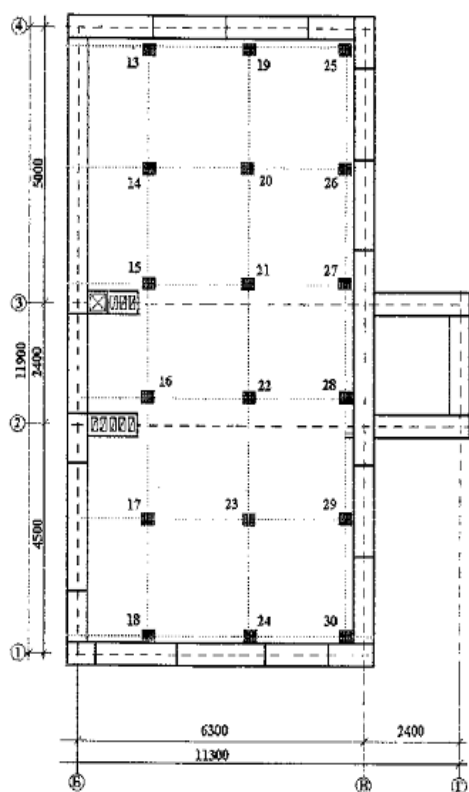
План расположения точек трехкомпонентных наблюдений на 3-м перекрытии
